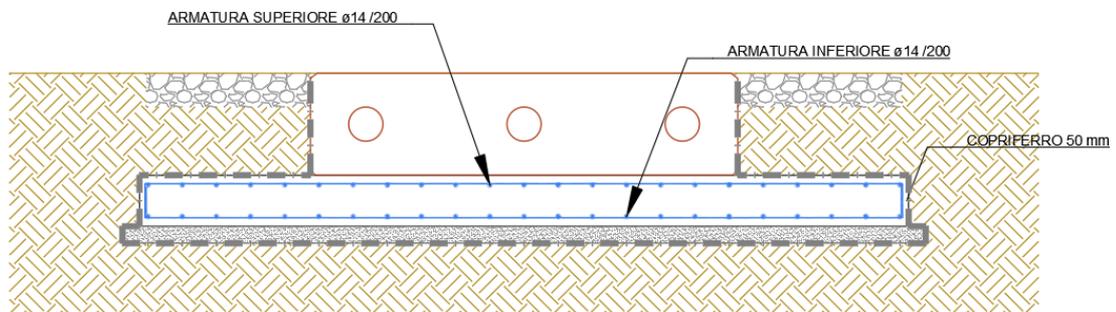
Sezione C-C della platea di Fondazione della Cabina di Centrale
